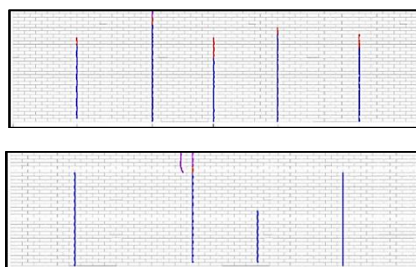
Трещины в кладке лицевого слоя продольных наружных стен экспериментального фрагмента здания [12]
